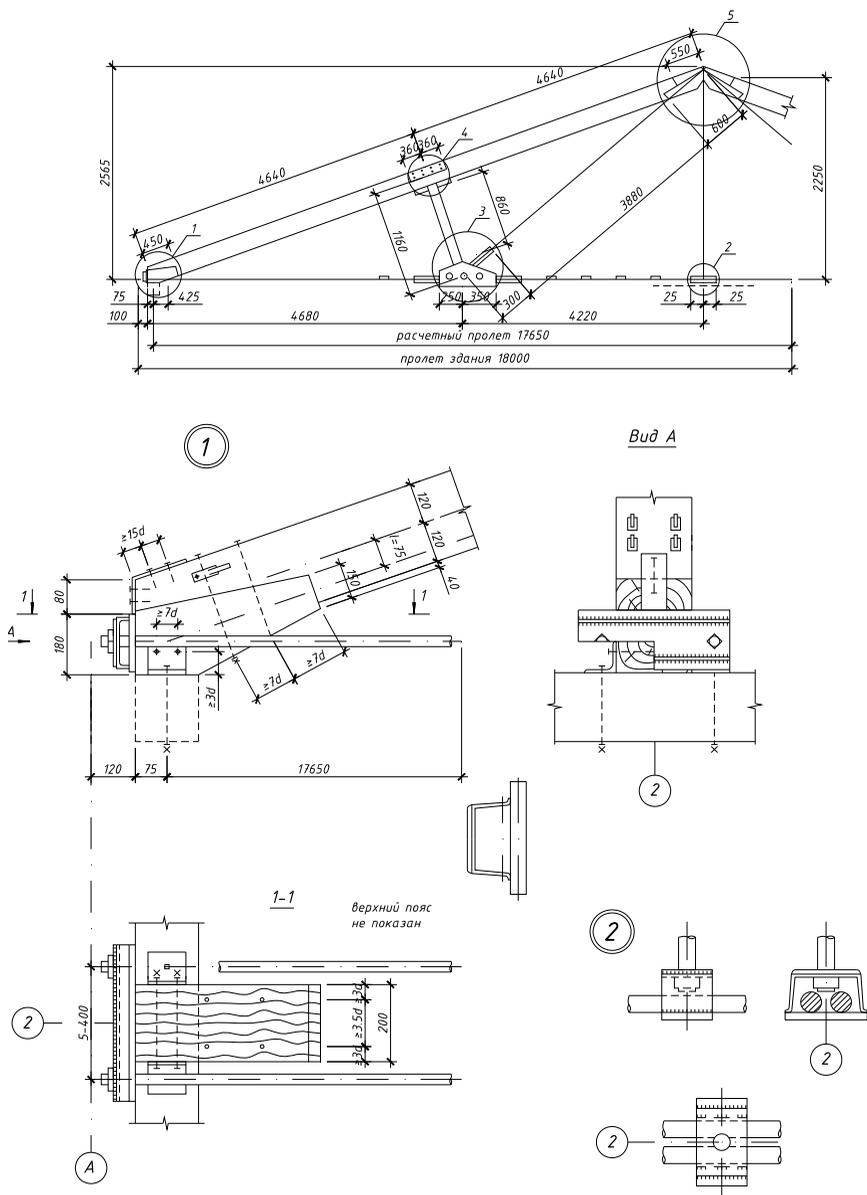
Треугольная крупнопанельная ферма с верхним поясом из цельных блоков
